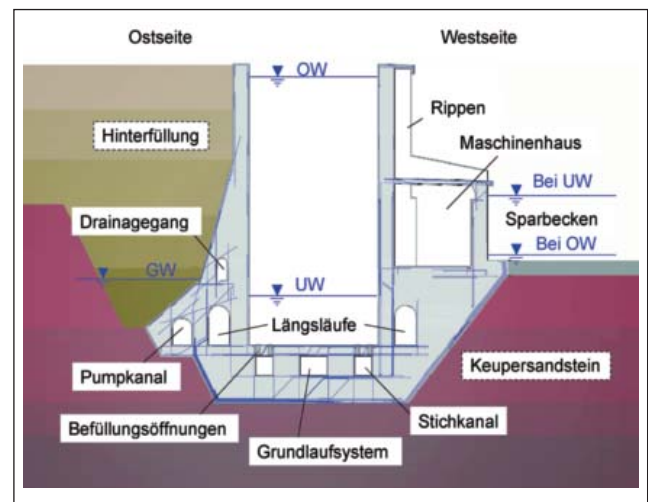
Querschnitt Schleusenammer Eibach mit Bewehrung und Baugrund
